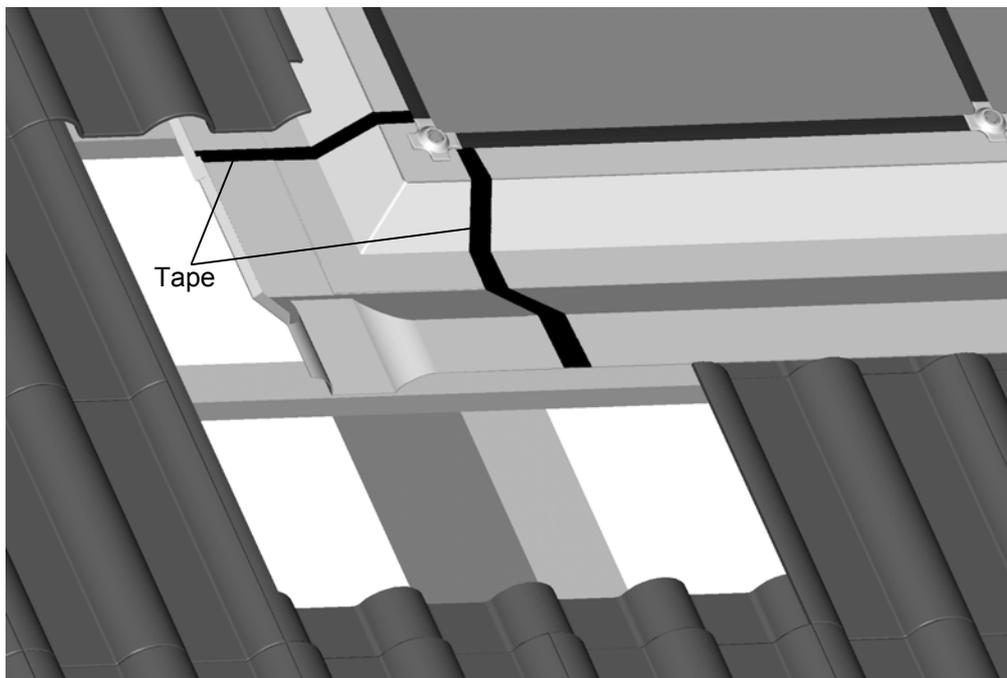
Dichten der Fugen um die Anschlusssecke mittels Tape
